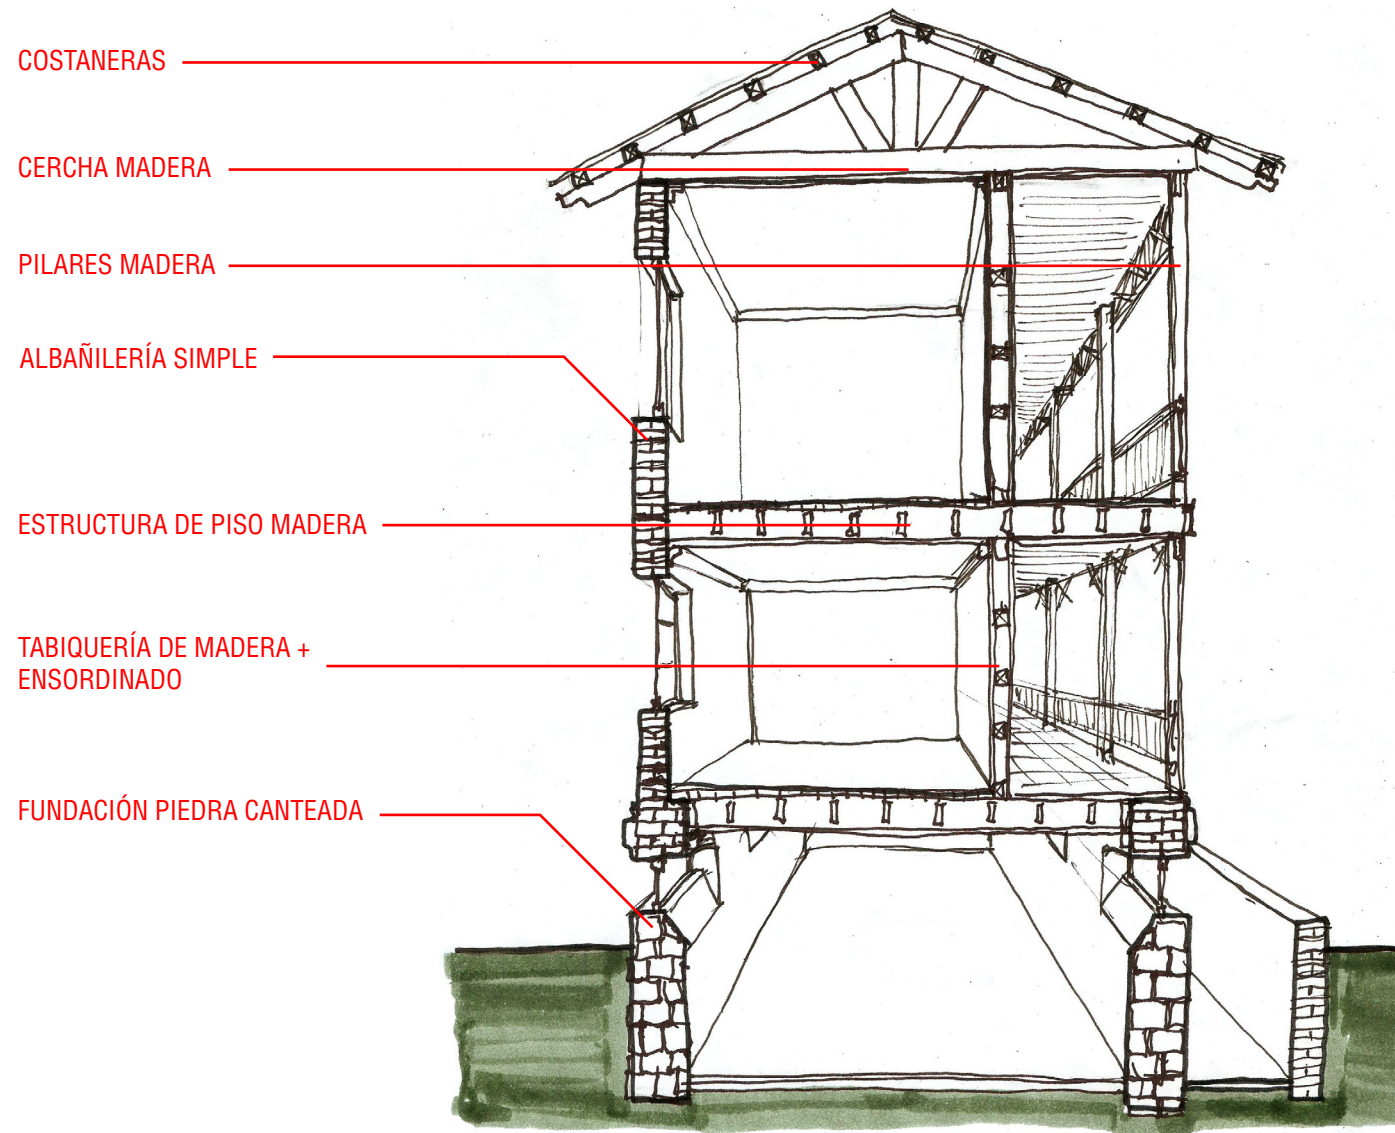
Corte constructivo esquemático del inmueble. Fuente: elaboración del autor.
